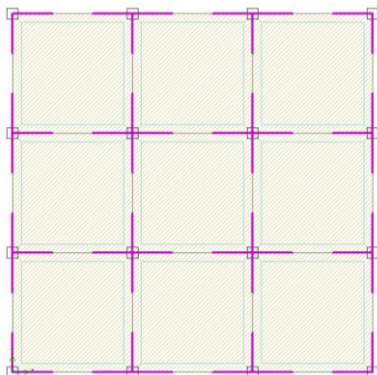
План типового этажа здания, выполненного в ПК МОНОМАХ.
